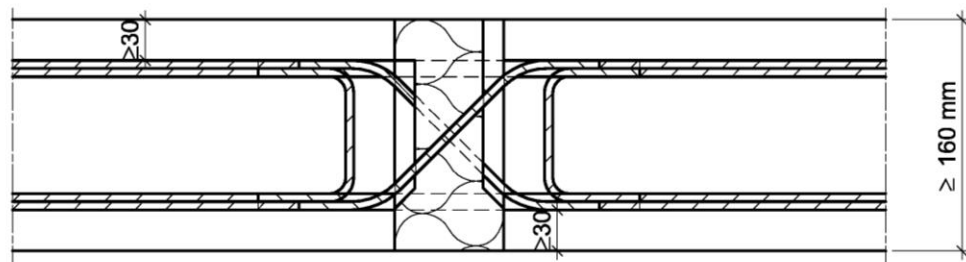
Beispiel Schöck Isokorb® Typ D mit Vertikalbewehrung
